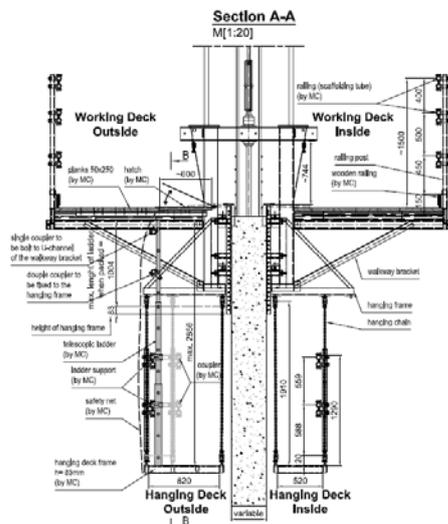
Coupe du coffrage glissant des voiles du caisson.
